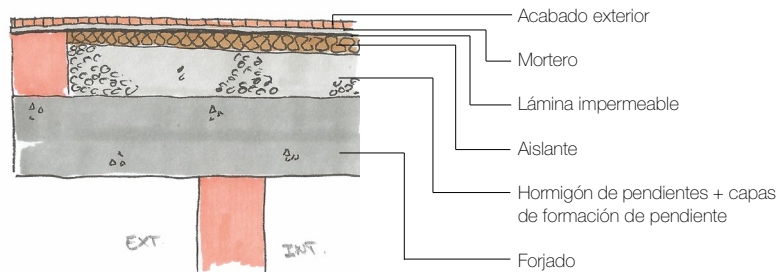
Detalle genérico en sección de cubierta plana convencional con aislamiento (autoría propia).
